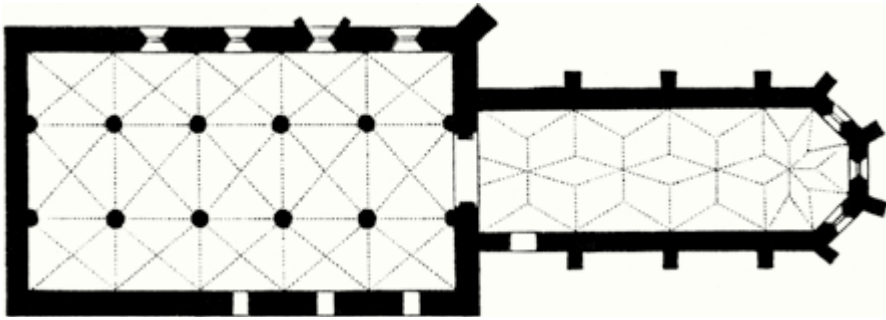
Grundriss der Dominikanerkirche in Retz
